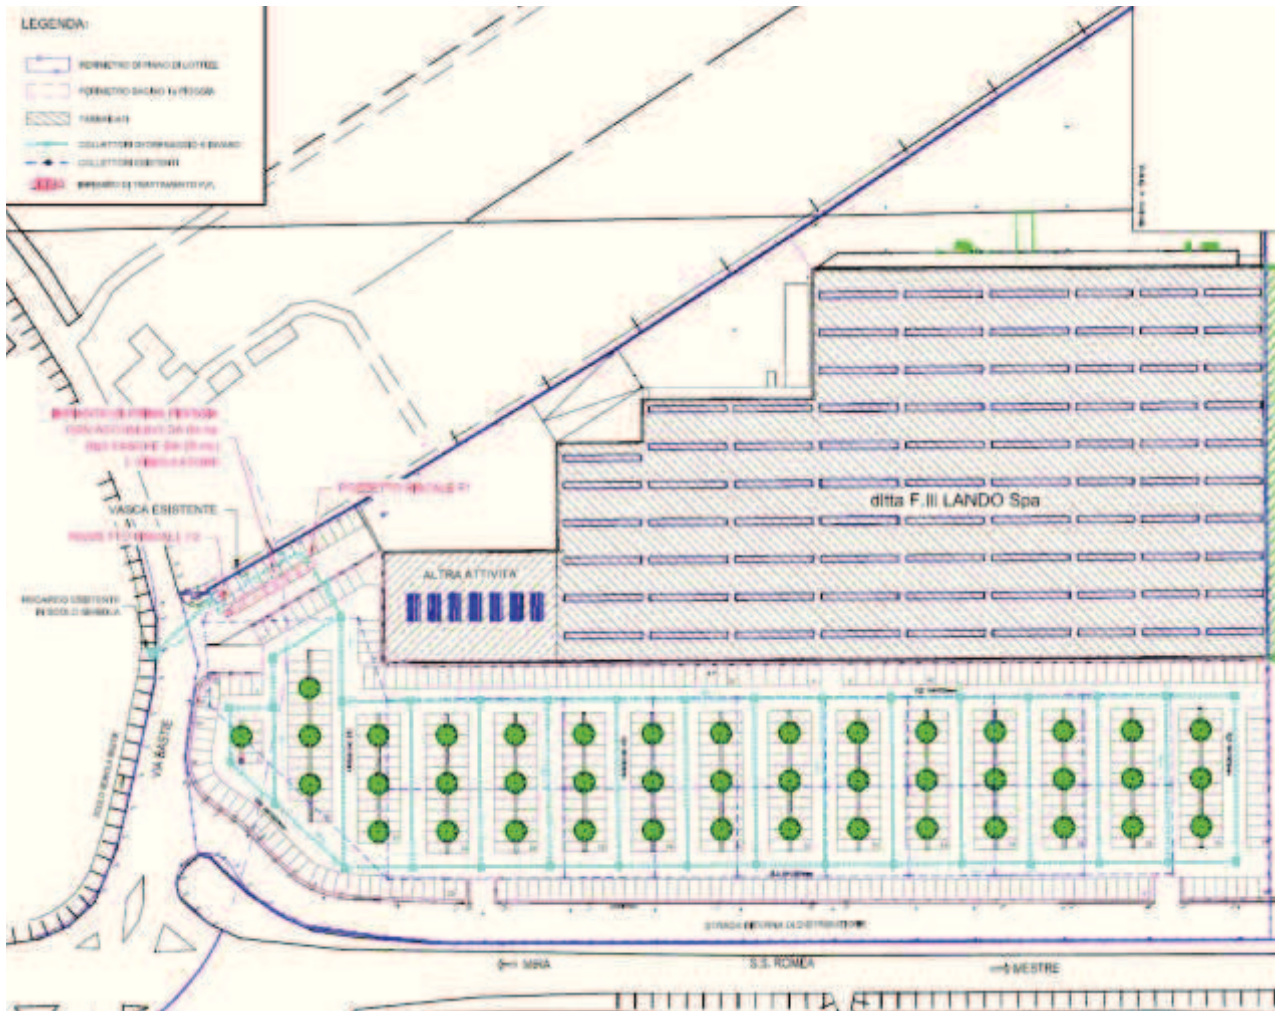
Estratto Tav. 02 progetto rete acque meteoriche
